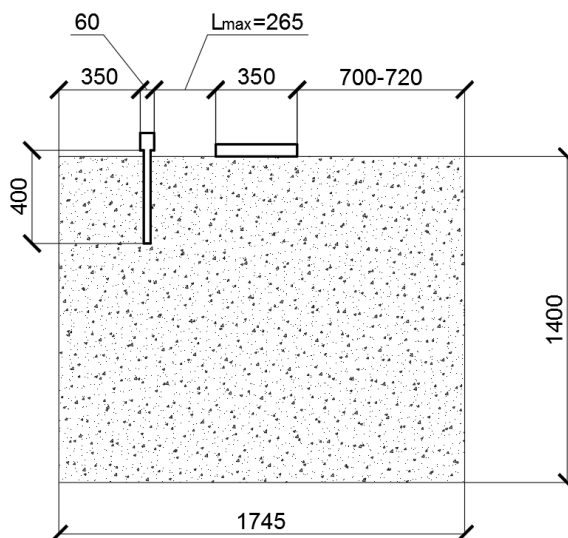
Схема грунтового массива и моделей ленточного свайного и плитного фундаментов
